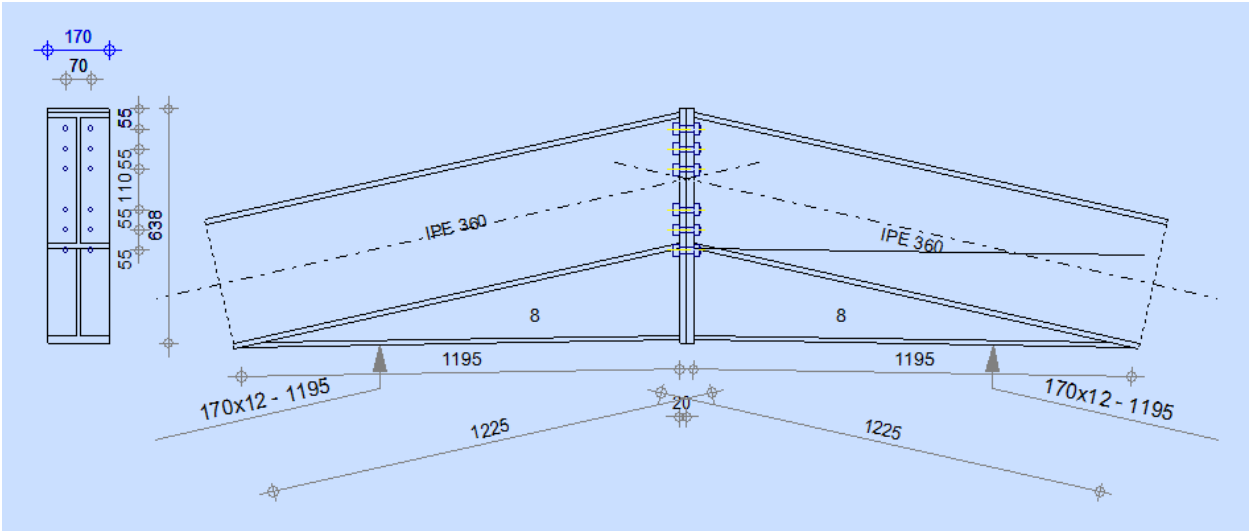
assemblage poutre IPE 360-poutre IPE 360
